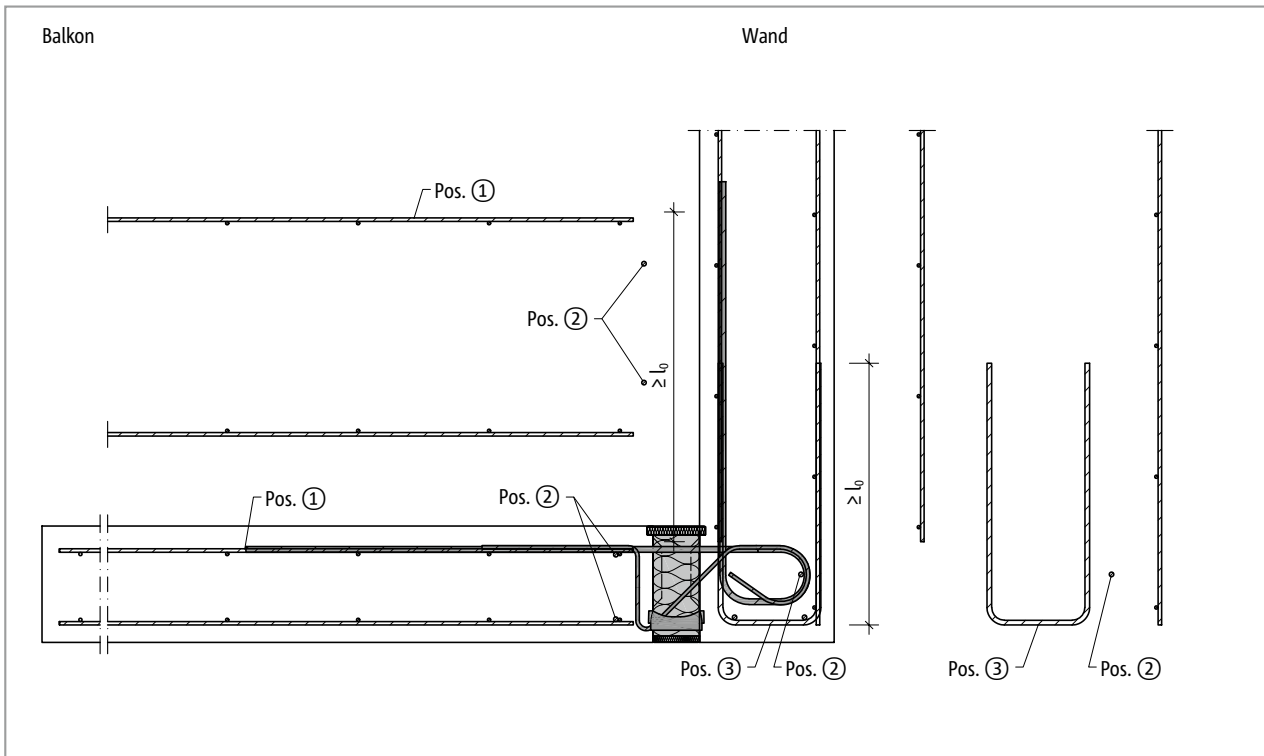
Schöck Isokorb® T Typ K-WO: Bauseitige Bewehrung
